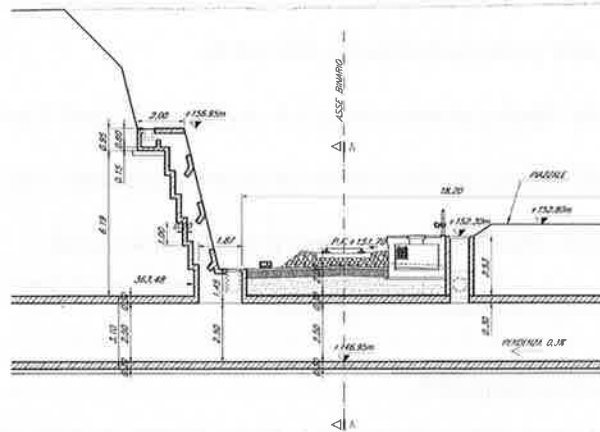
SEZIONE LONGITUDINALE TIPOLOGICA
